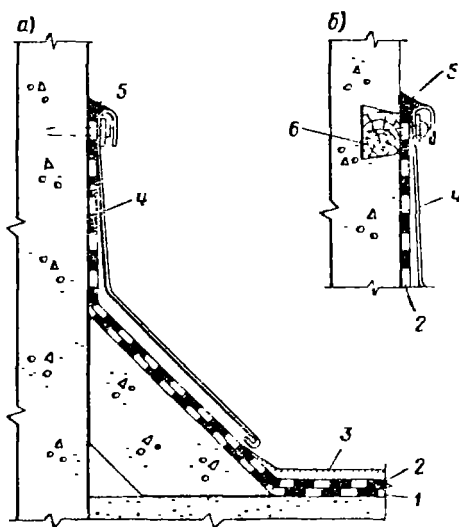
Пример устройства кровель у примыкания к бетонным поверхностям
